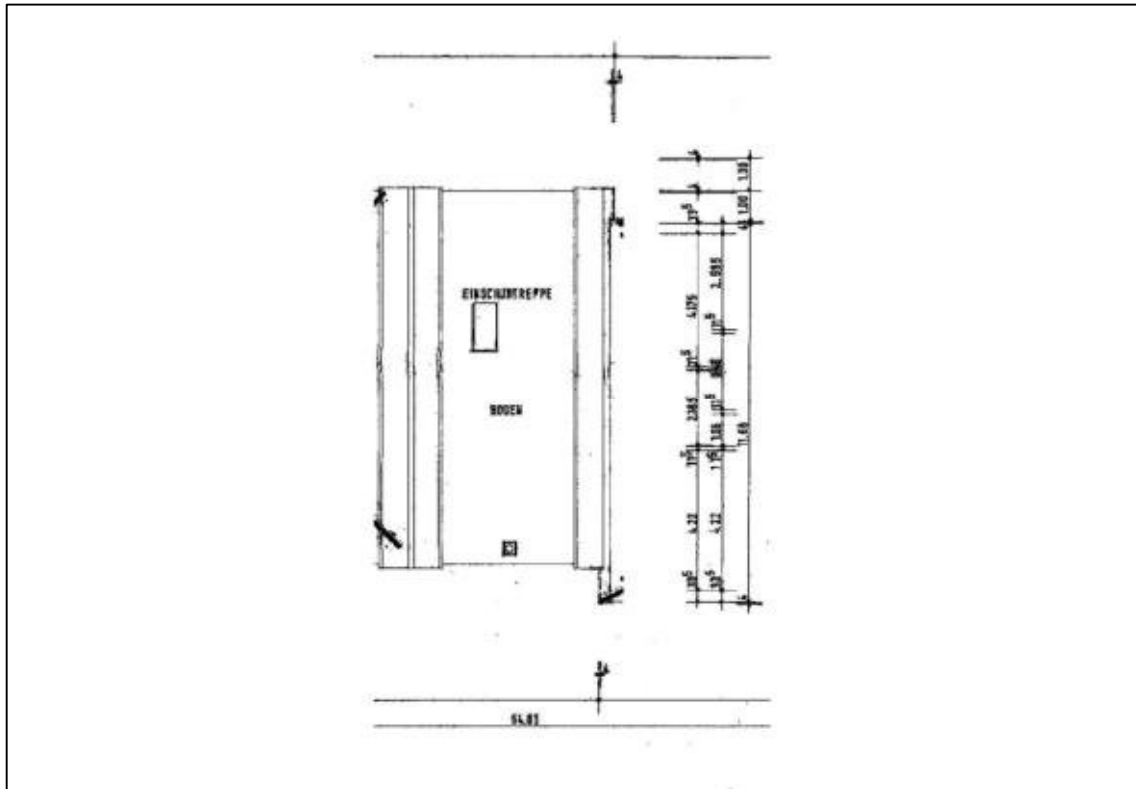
Grundriss vom Dachgeschoss
